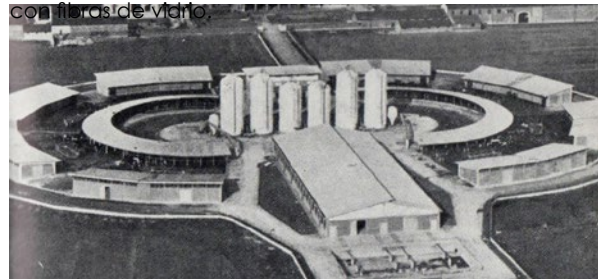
Grupo SAMCA. Batería de silos de GFRP. Fuente: D'Arzié, Duilio. (1977). Los plásticos reforzados con fibras de vidrio.
